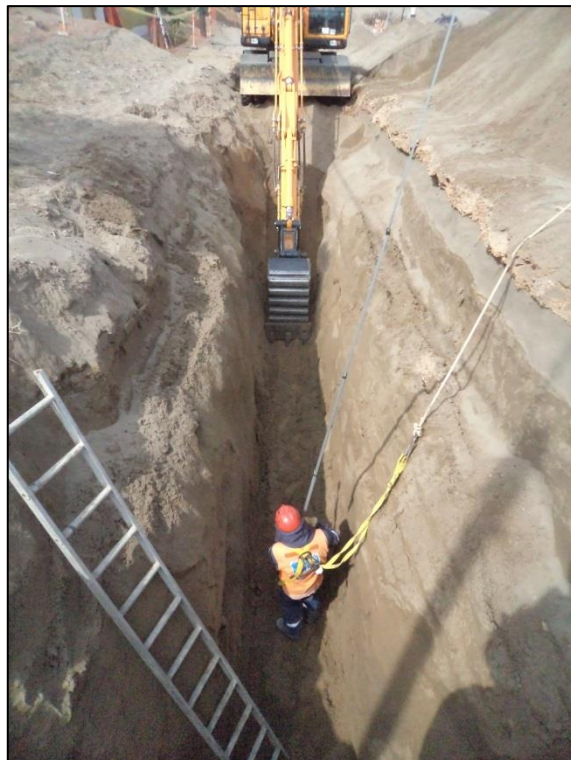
Culminación de aplicación de excavación tipo III en red de alcantarillado (TIII-002).
